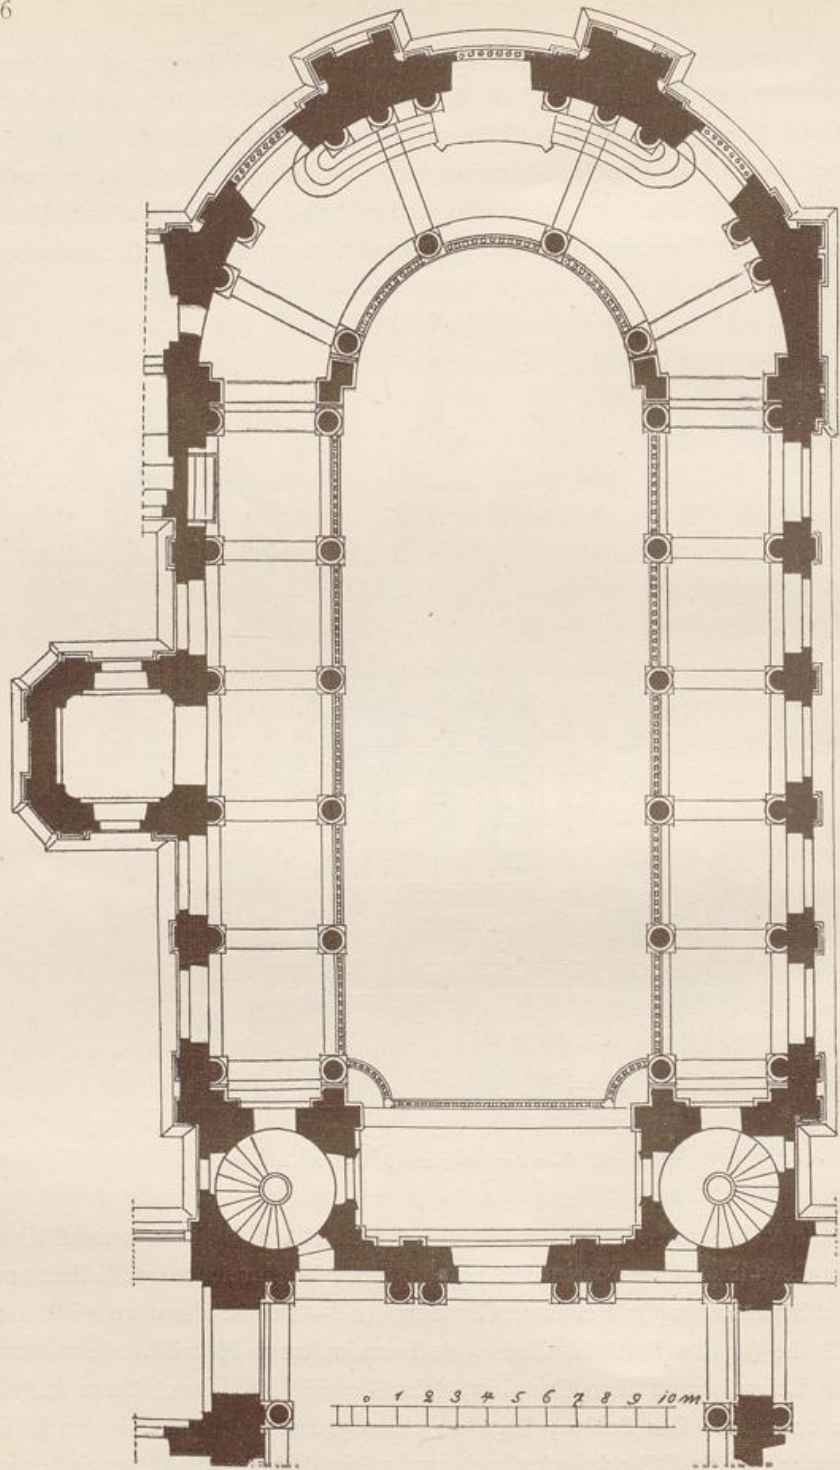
Kapelle von Versailles. Grundriss.
